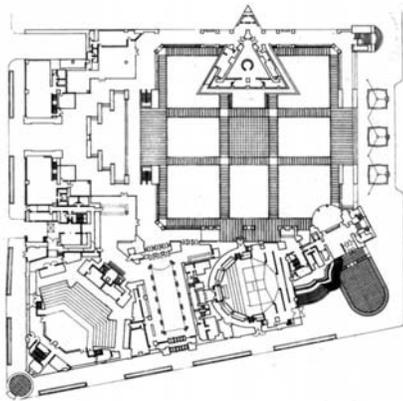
Planta geral do complexo cultural Art Tower, projeto de Arata Isosaki
